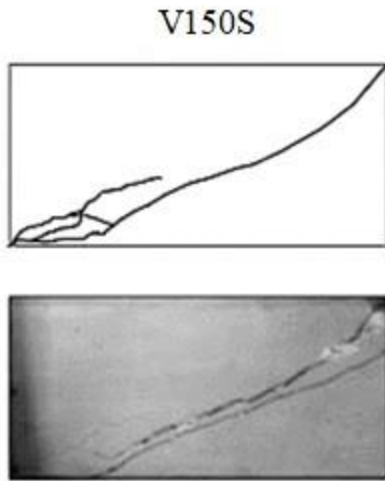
Padrão de fissuração da viga V150S.
